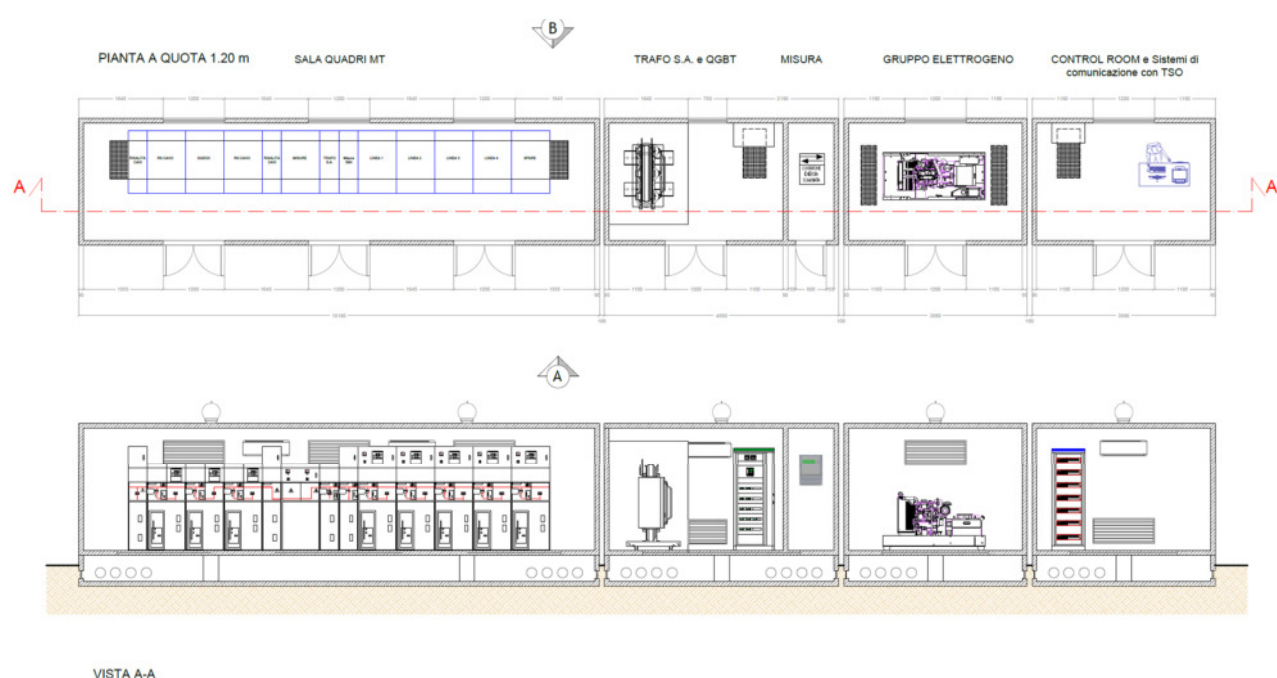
Particolare pianta e sezione cabina di raccolta e smistamento (rif. FV.ALC01.PD.H.02)
